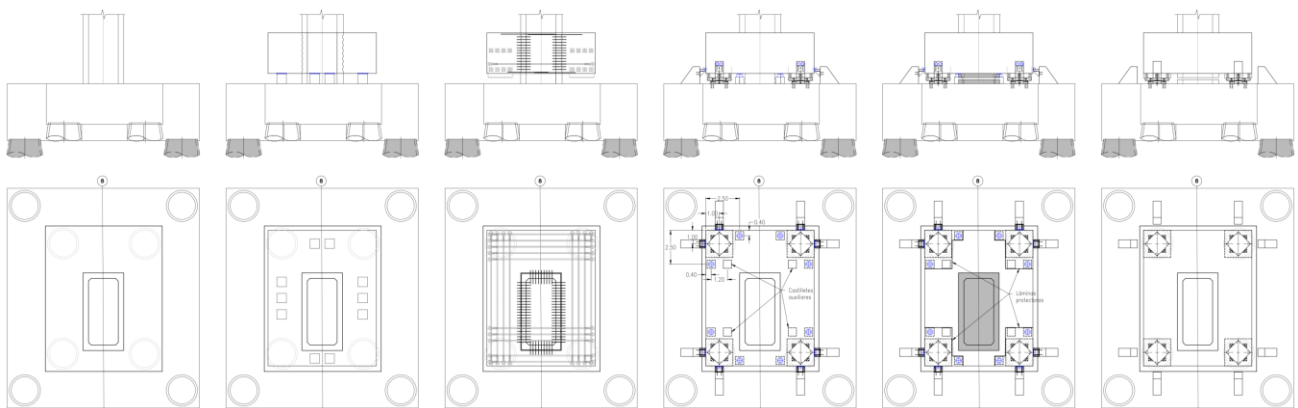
Secuencia de ejecución de bloques en la base de las pilas aisladas.
